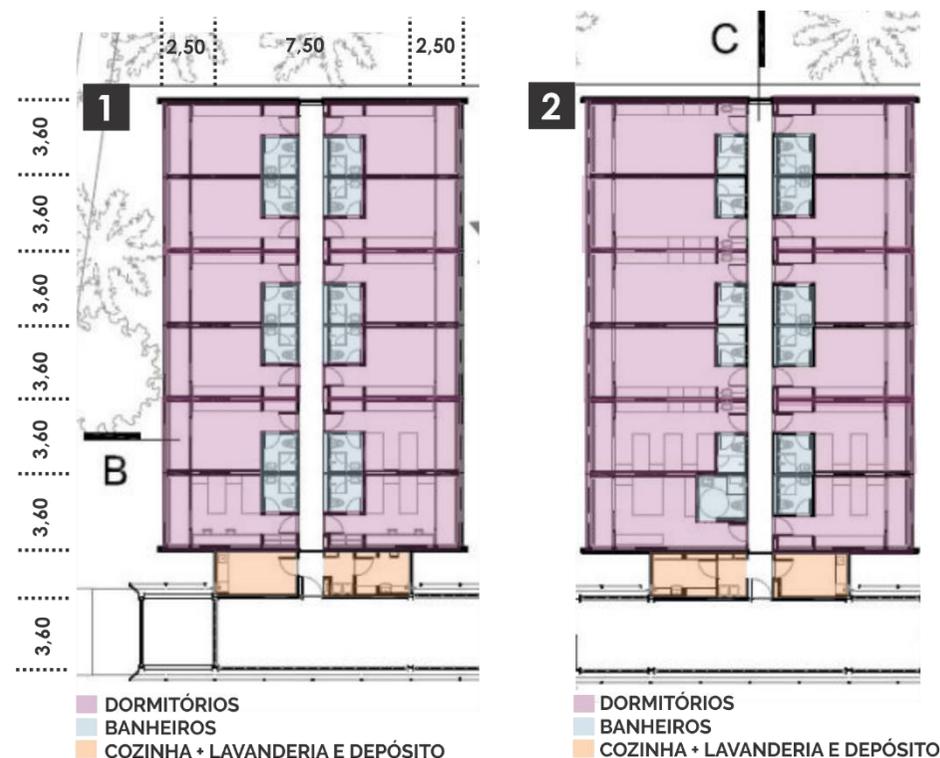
Alojamento Estudantil, Ciudad del Saber, planta baixa térreo.
